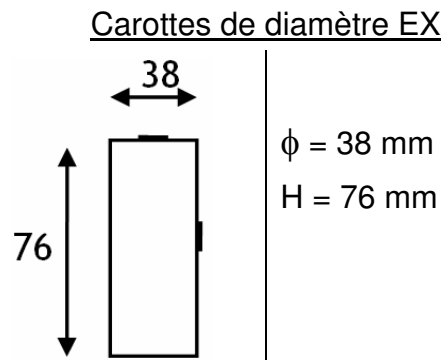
Géométrie et dimensions des éprouvettes en ciment
